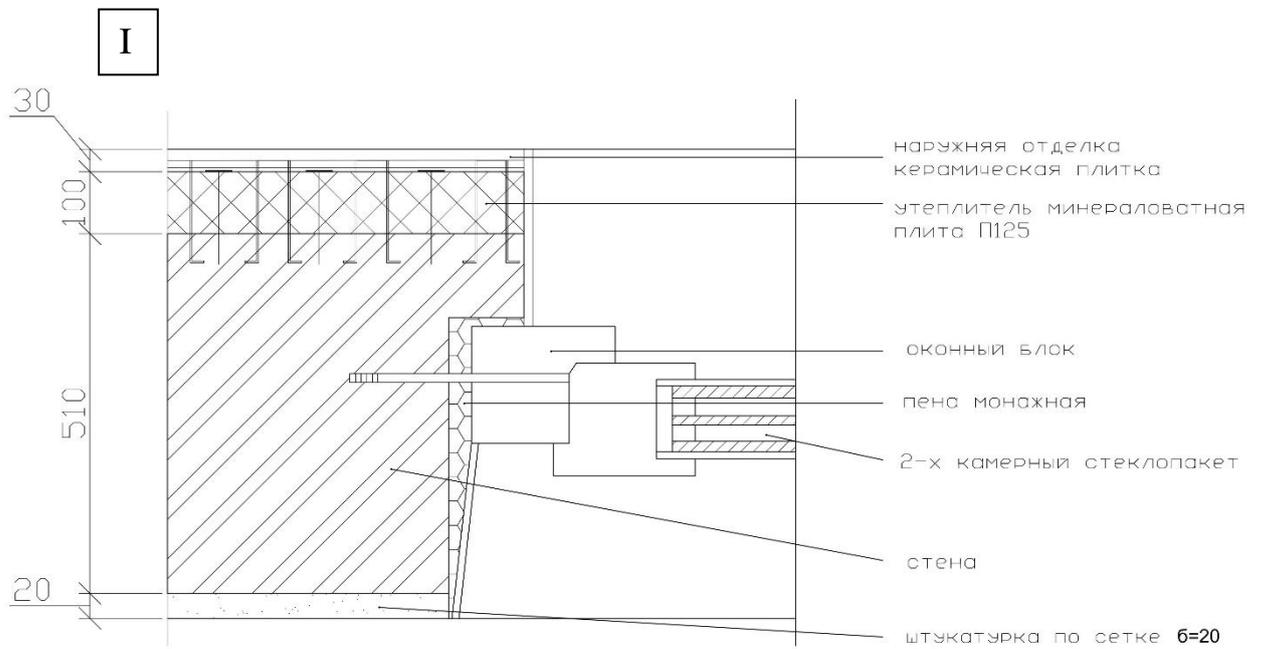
Узел горизонтального сечения примыкания оконного блока к стене
